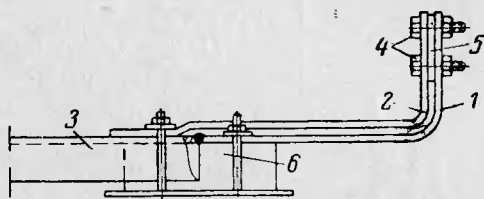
Приварка плоских шин к шинам коробчатого сечения.
